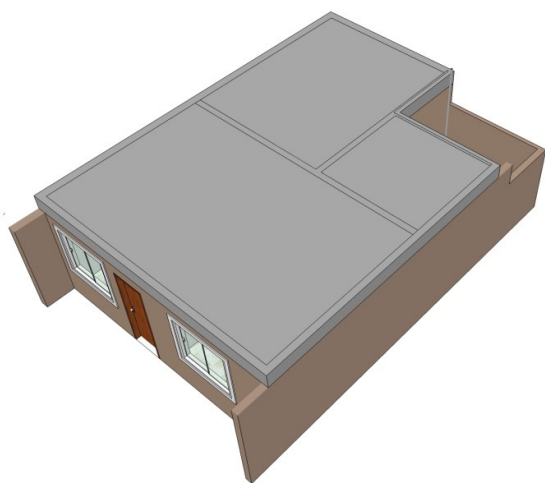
Laje de concreto pré-moldado com lajota cerâmica.
